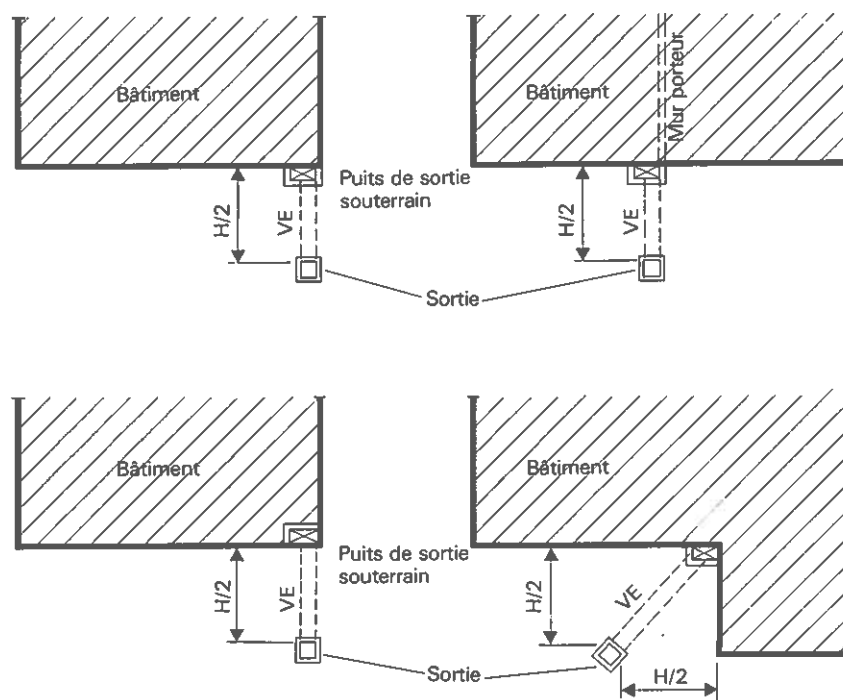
Disposition du puits de sortie dans le cas d'un abri en profondeur (vue en plan)
